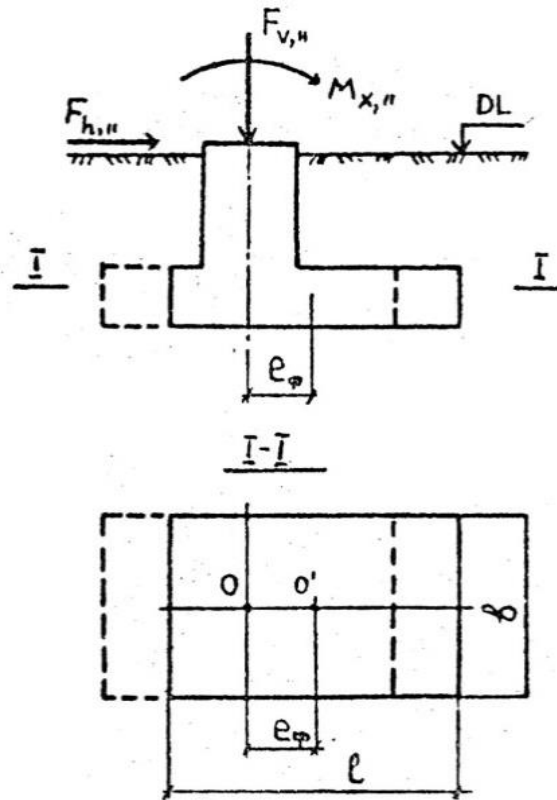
Схемы размещения подошвы фундамента относительно оси колонны при центральном нагружении (пунктирная линия); при действии значительных по величине моментов (сплошная линия): O – точка пересечения оси колонны с подошвой фундамента; O' – геометрический центр подошвы фундамента.
